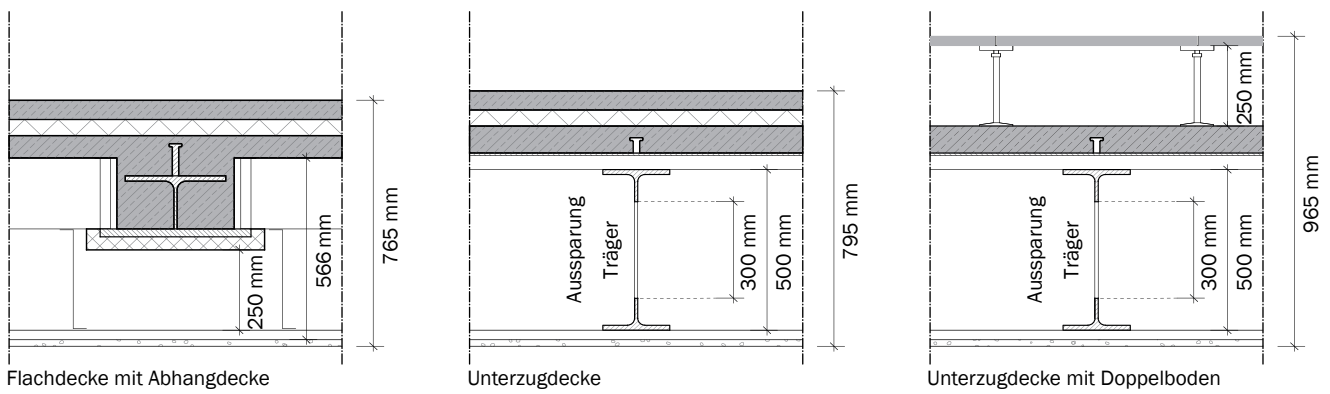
Raumbedarf von Deckentragwerken inklusive Installationsraum für Elemente der TGA
